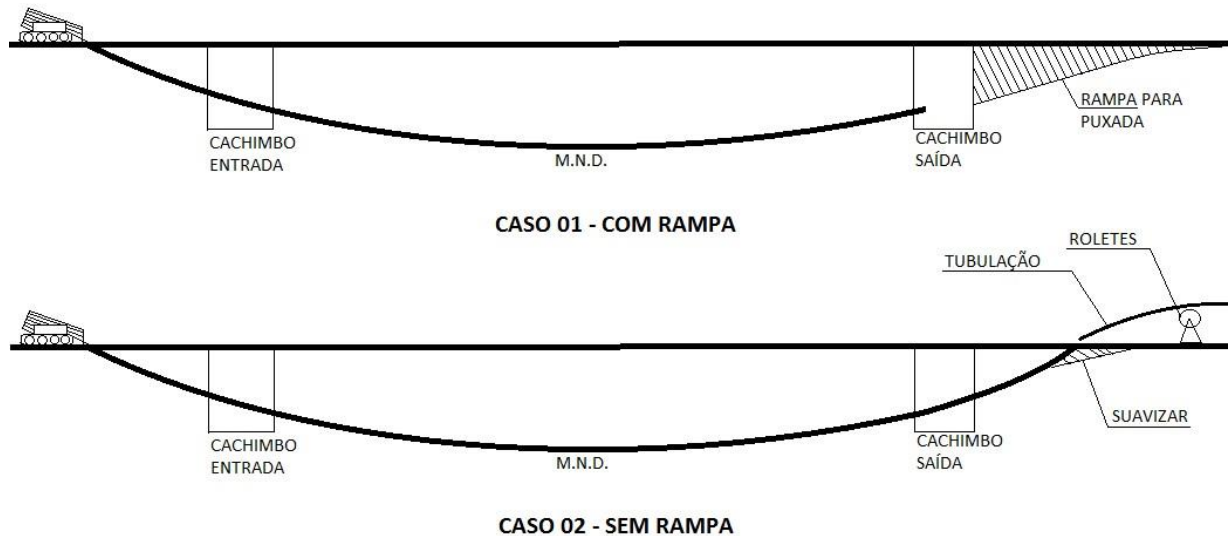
Ilustração de perfil de M.N.D. com ou sem rampa.
